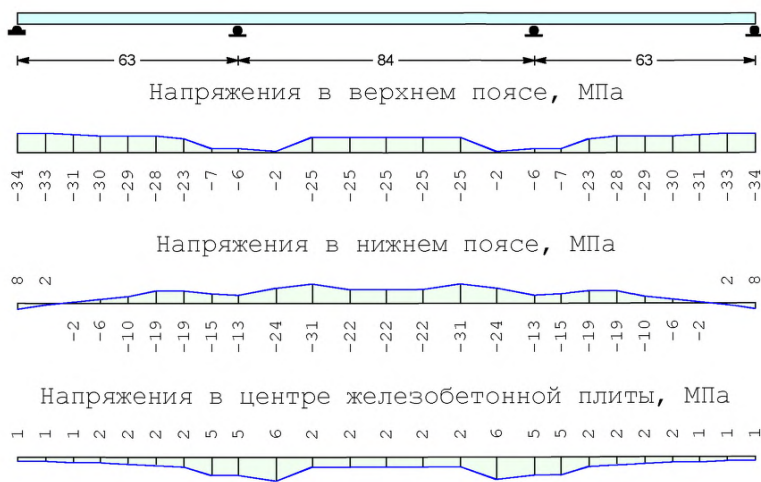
Эпюры напряжений от воздействия усадки бетона
